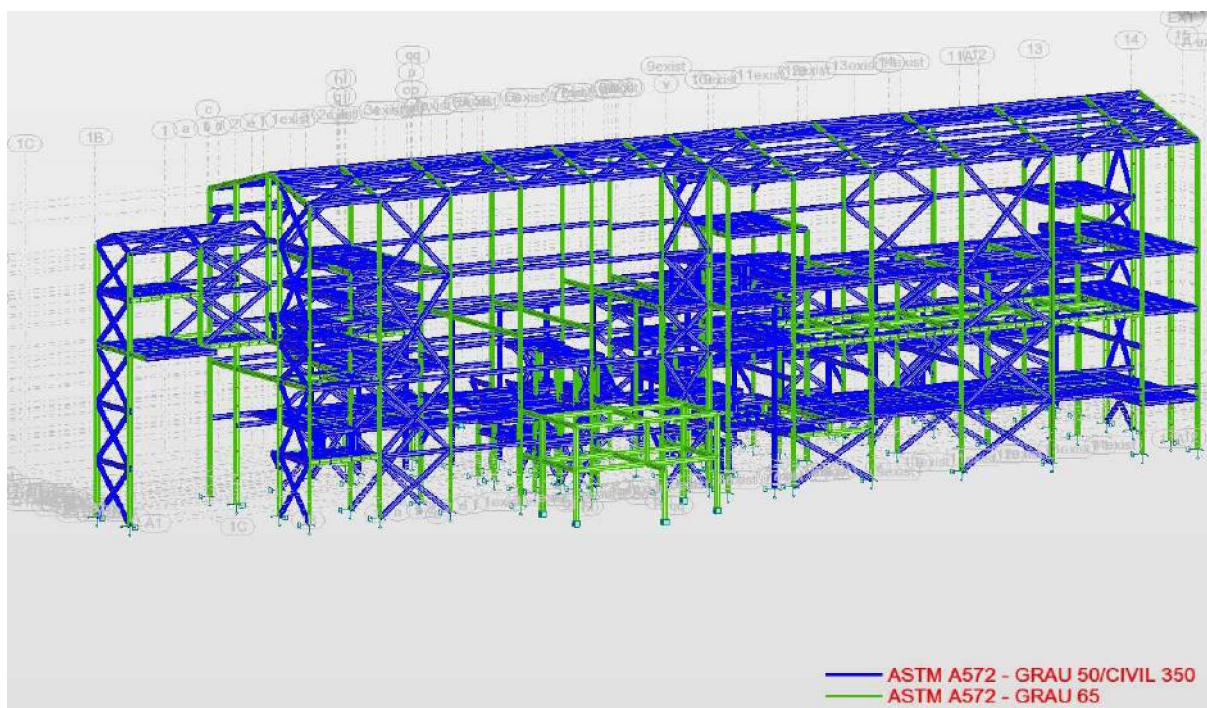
Vista lateral do prédio projetado com estrutura mista
